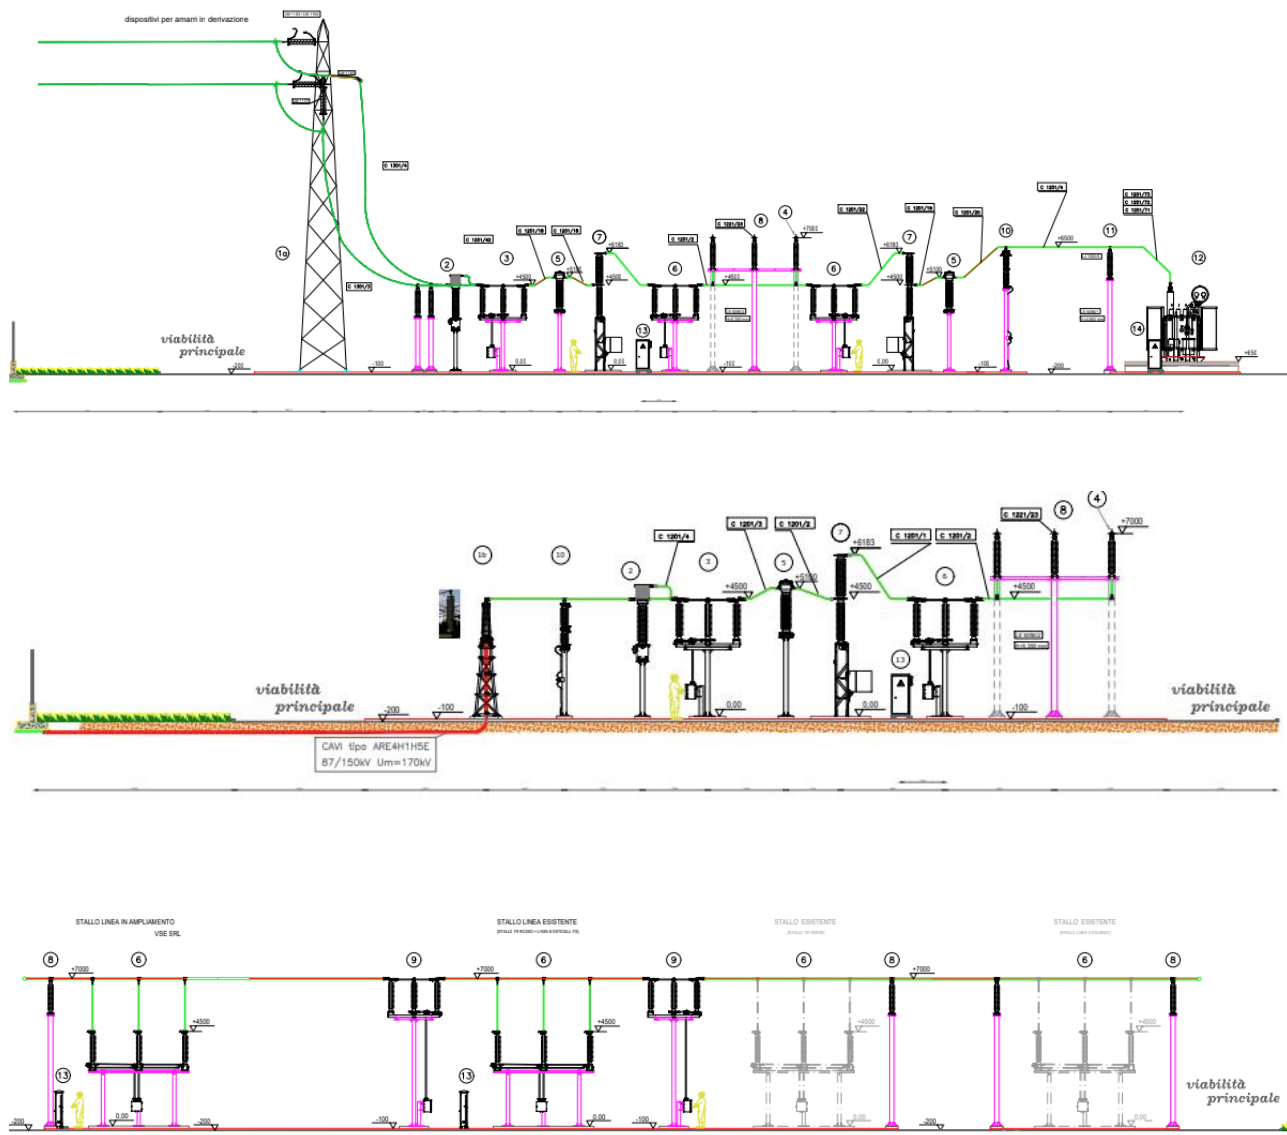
Sezioni dell'impianto CORTEMAGGIORE (fonte: tavole di progetto)
